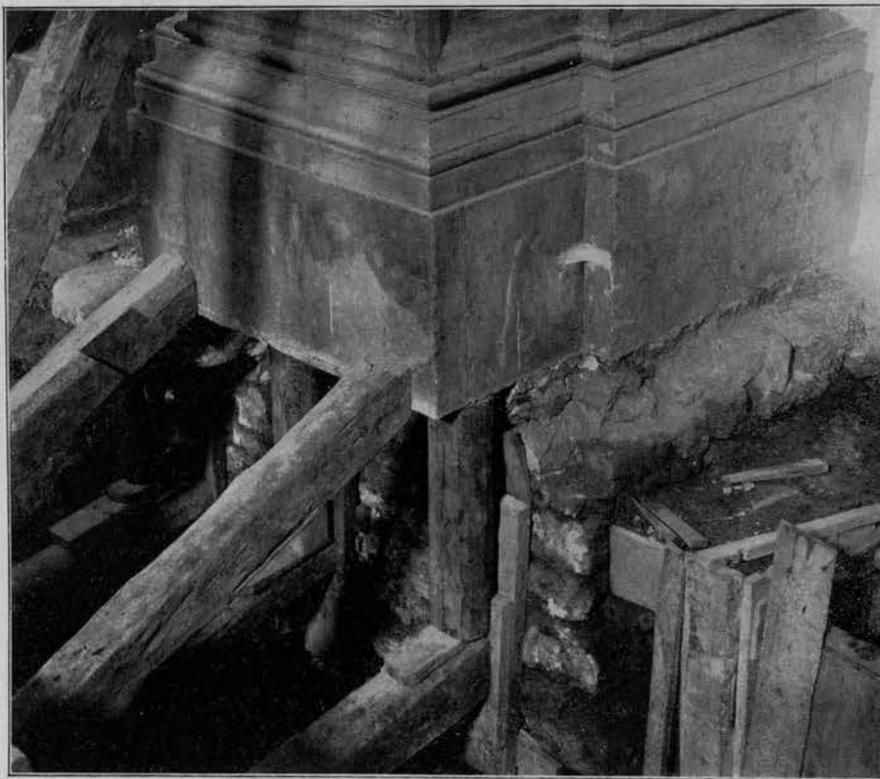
Fondazioni della pilastrata presso la Cappella S. Pietro.
